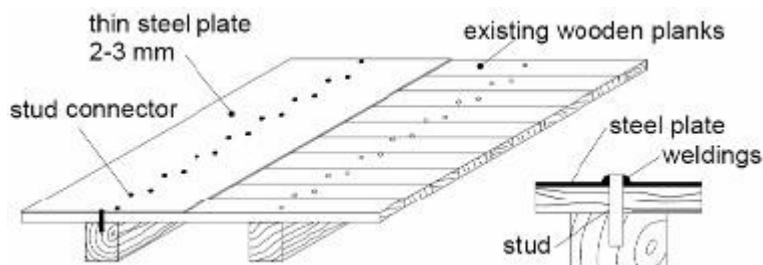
Aplicação de chapas metálicas sobre soalho existente (Marini et al.;2006).
